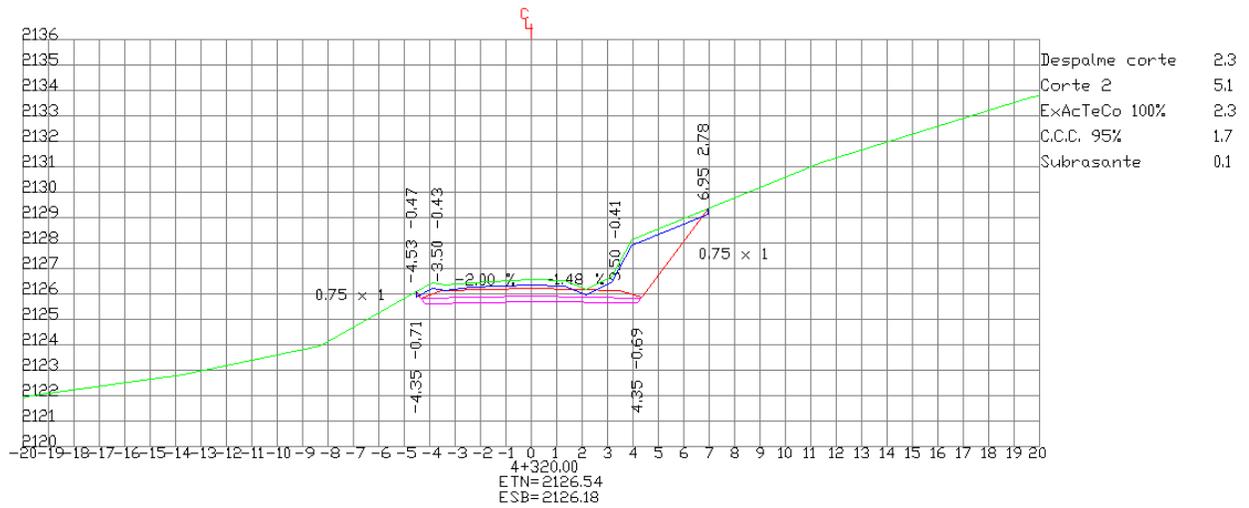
Sección transversal, km 4+320, en zona donde se requiere defensa metálica lado izquierdo.
